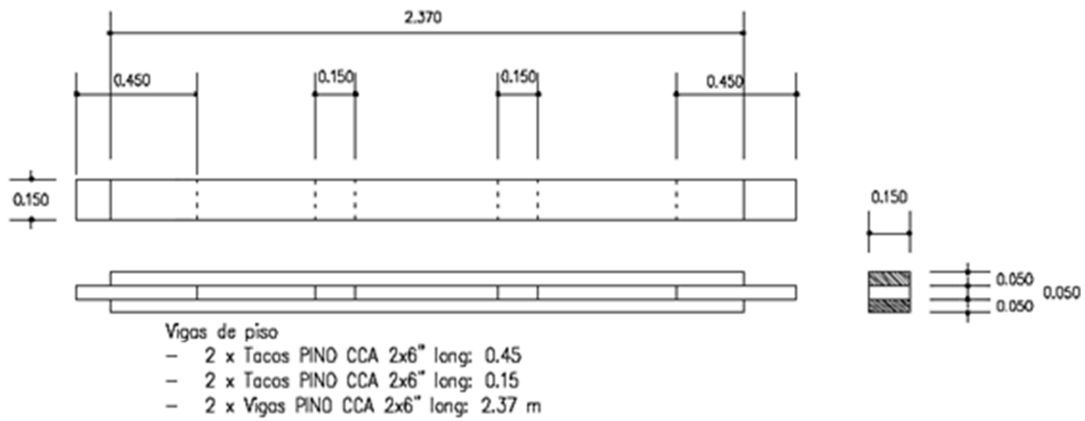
Detalle constructivo de la viga de piso principal. Fuente: Documentación provista por TECHO.
